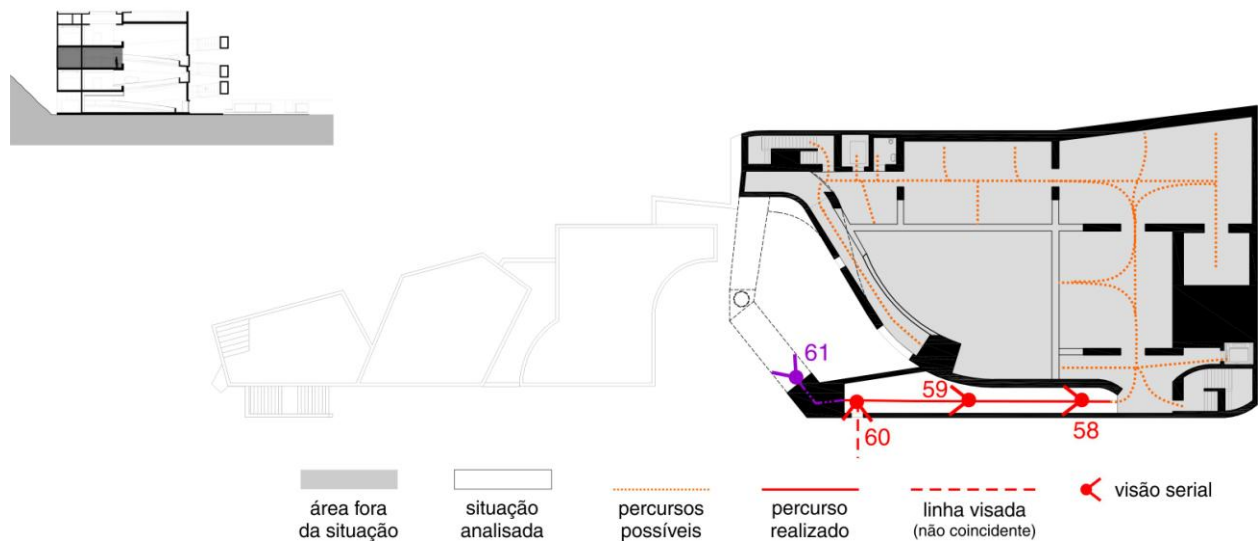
| FIC – Planta Terceiro Pavimento | Desenho da Autora
